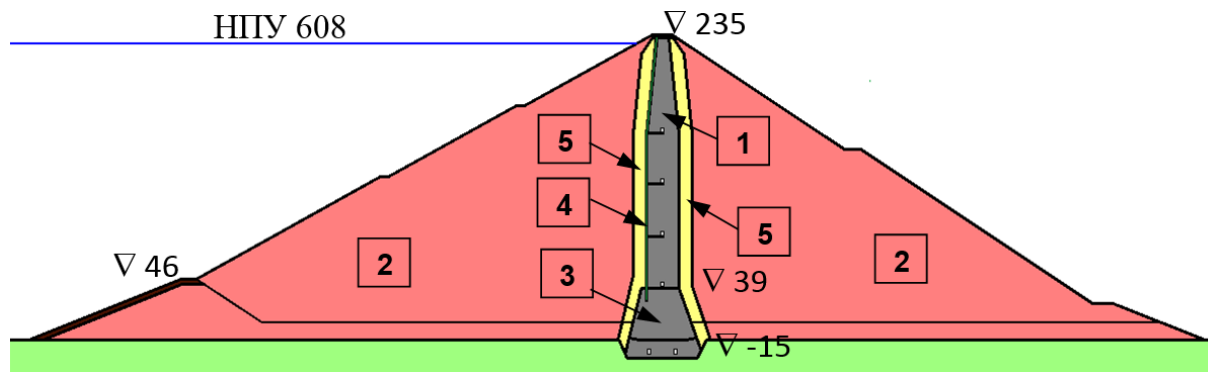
Схема устройства каменно-набросной плотины с бетонным ядром:
